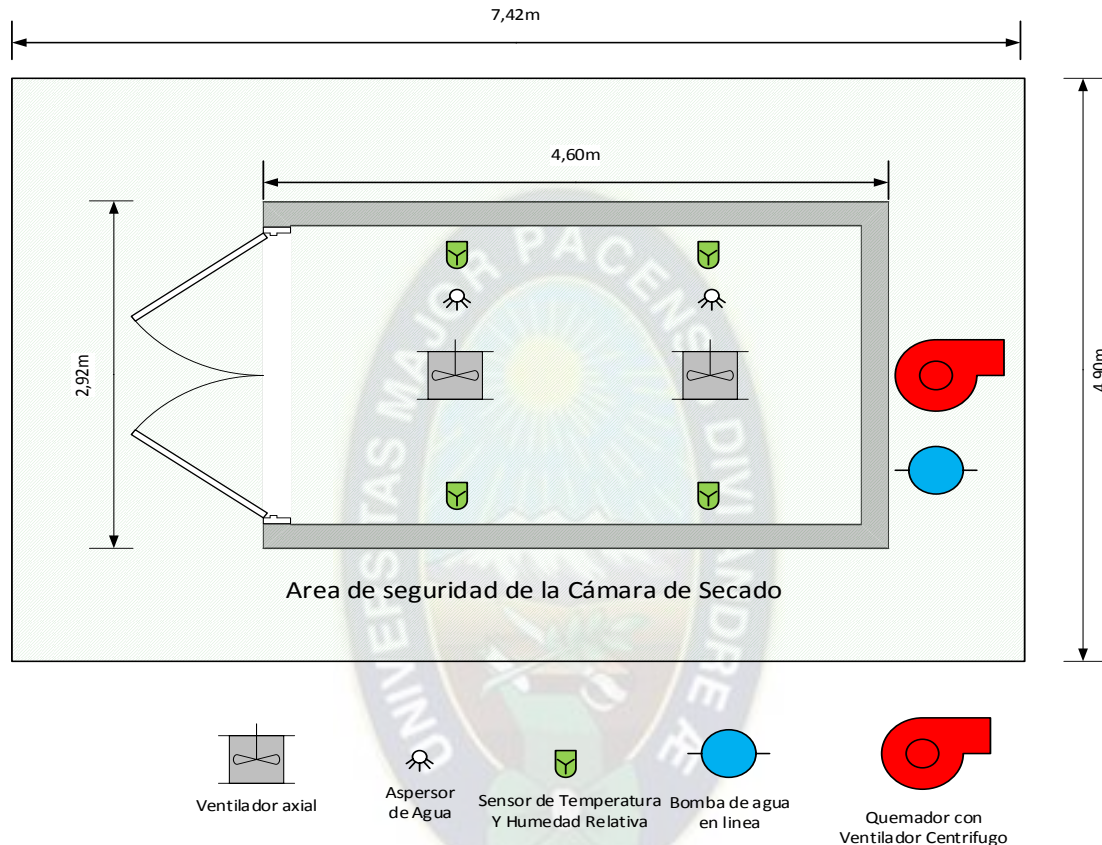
Disposición de sensores y actuadores, vista de planta de la cámara de secado.
